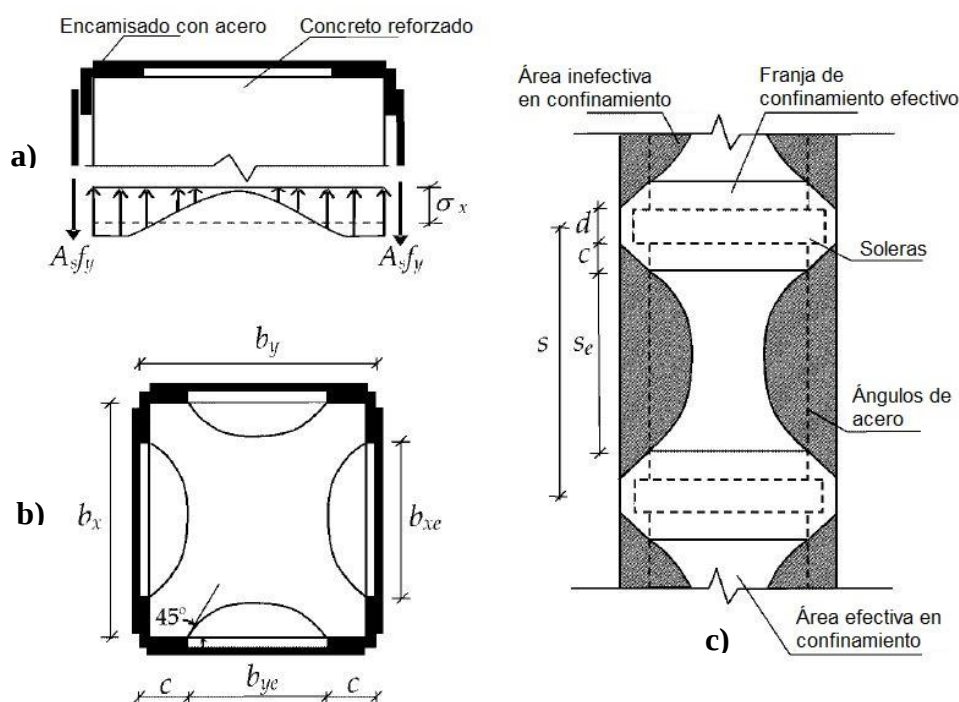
Confinamiento con encamisado metálico a la columna de concreto reforzado: *a)* equilibrio de fuerzas de confinamiento, *b)* confinamiento efectivo en planta y *c)* confinamiento efectivo en elevación.
